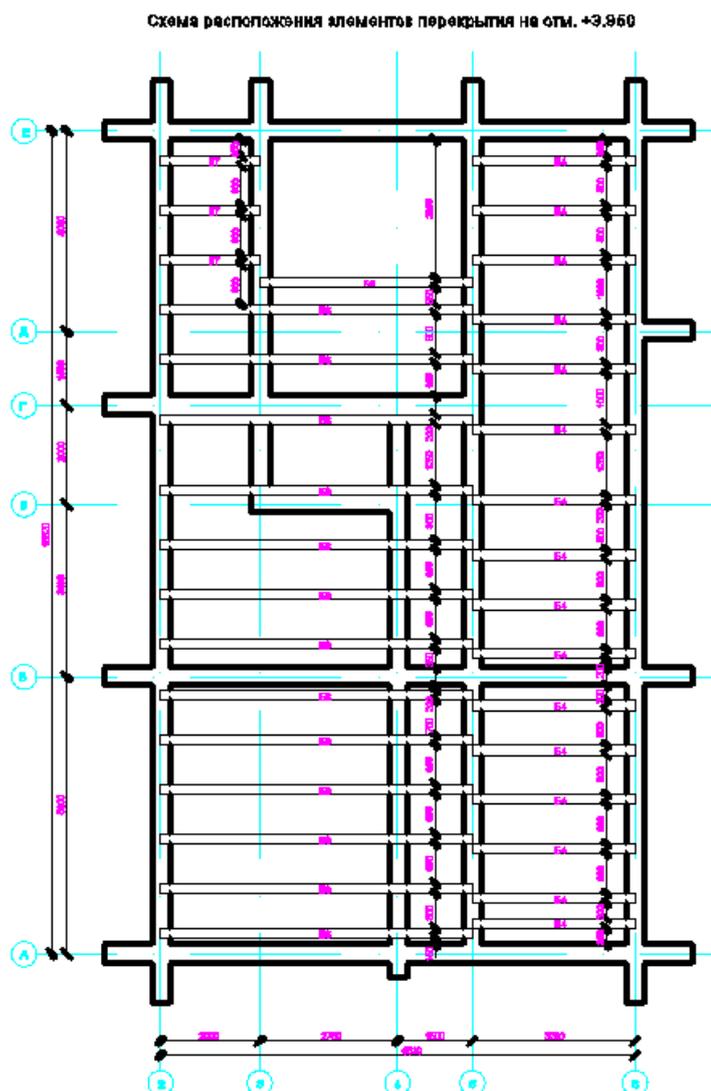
Схема расположения балок перекрытия на отм.+3,960
